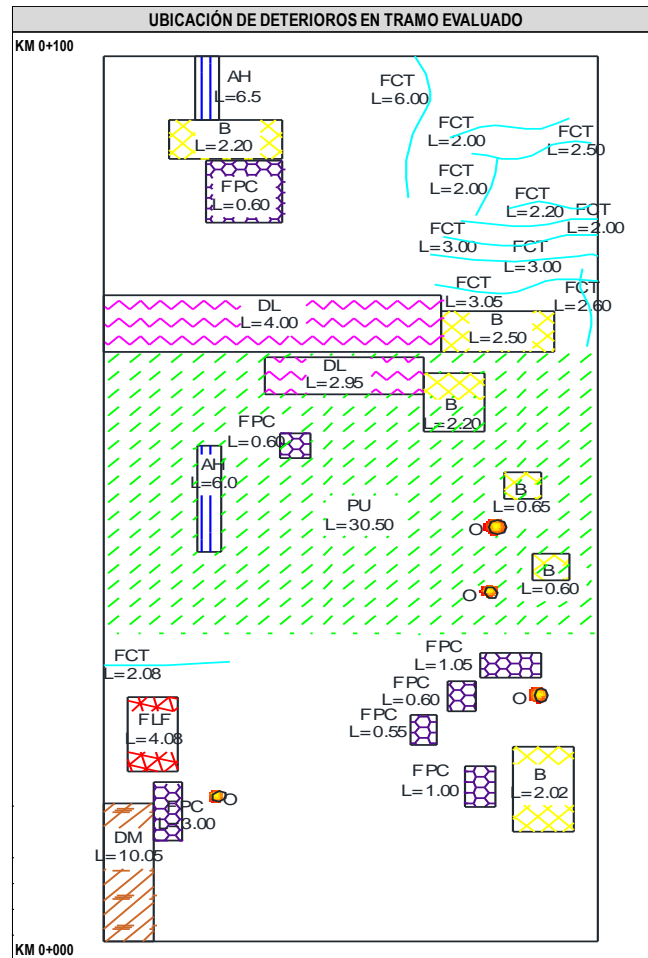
Llenado del formato de inspección para pavimentos asfálticos – VIZIR - “B”
